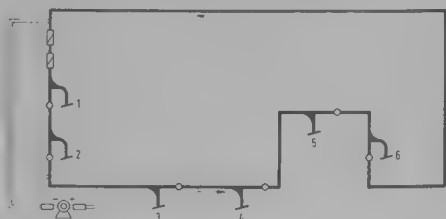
Rohrplan einer handgesteuerten Kreislaufweichenanlage.
